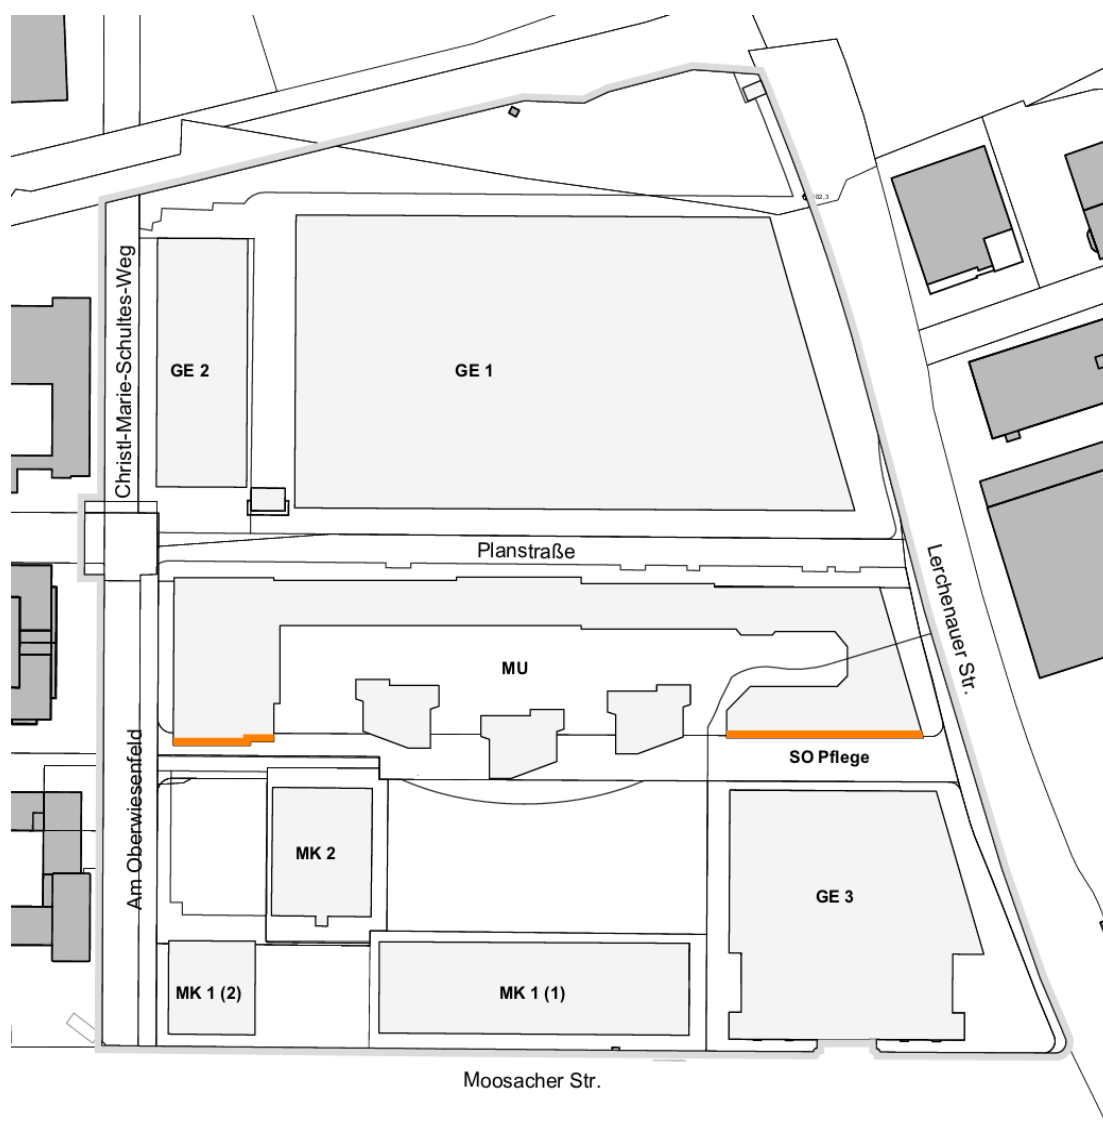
Fassadenphotovoltaik – ohne Maßstab
